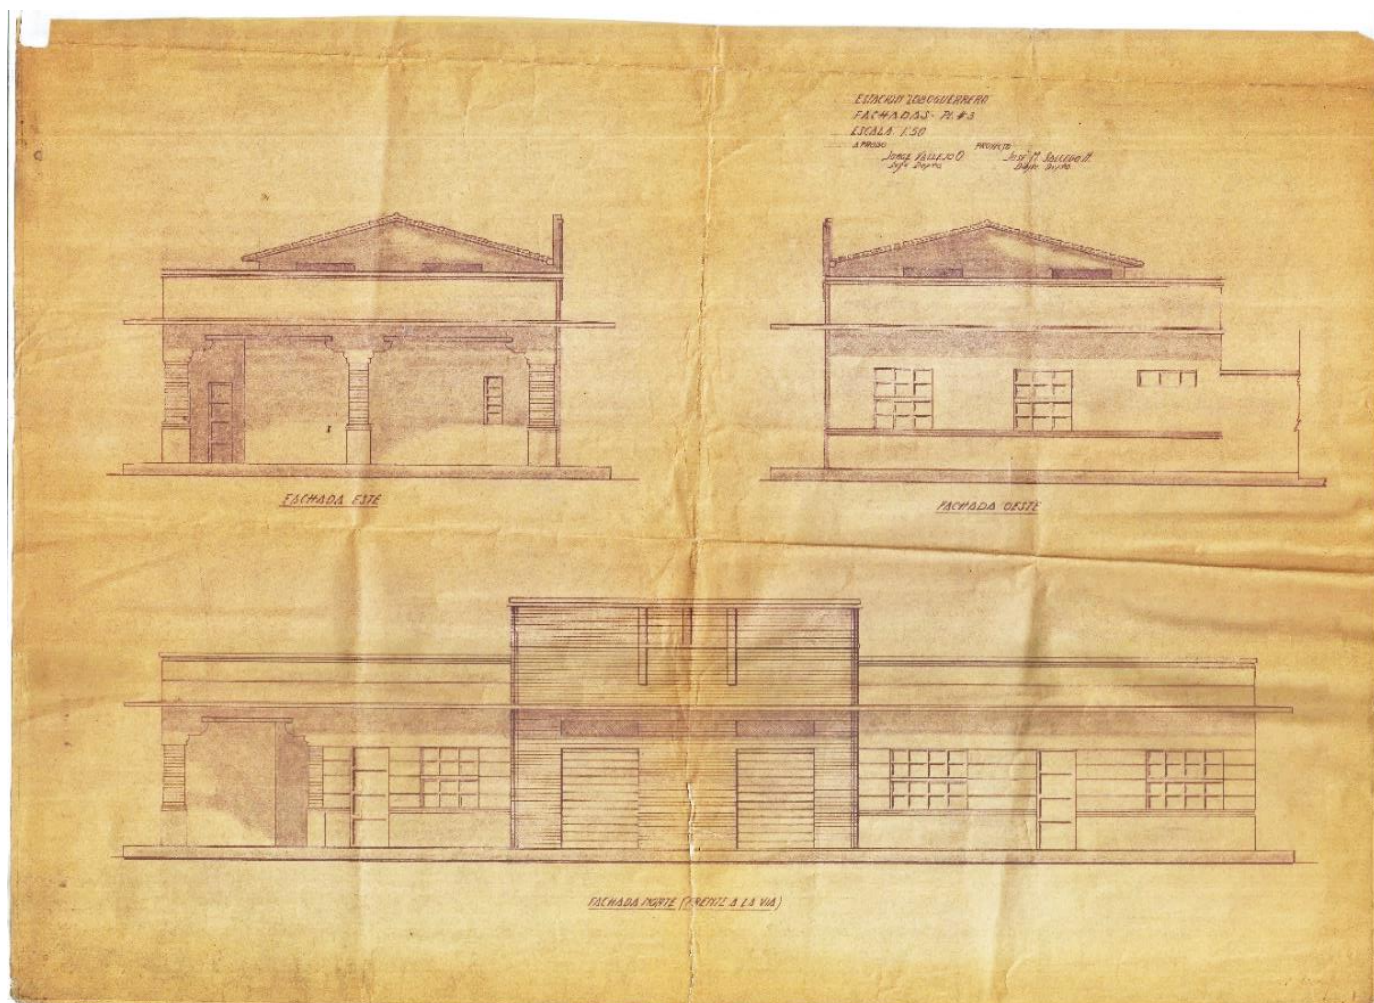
Plano Arquitectónico: Estación Loboguerrero. Plano 3.
